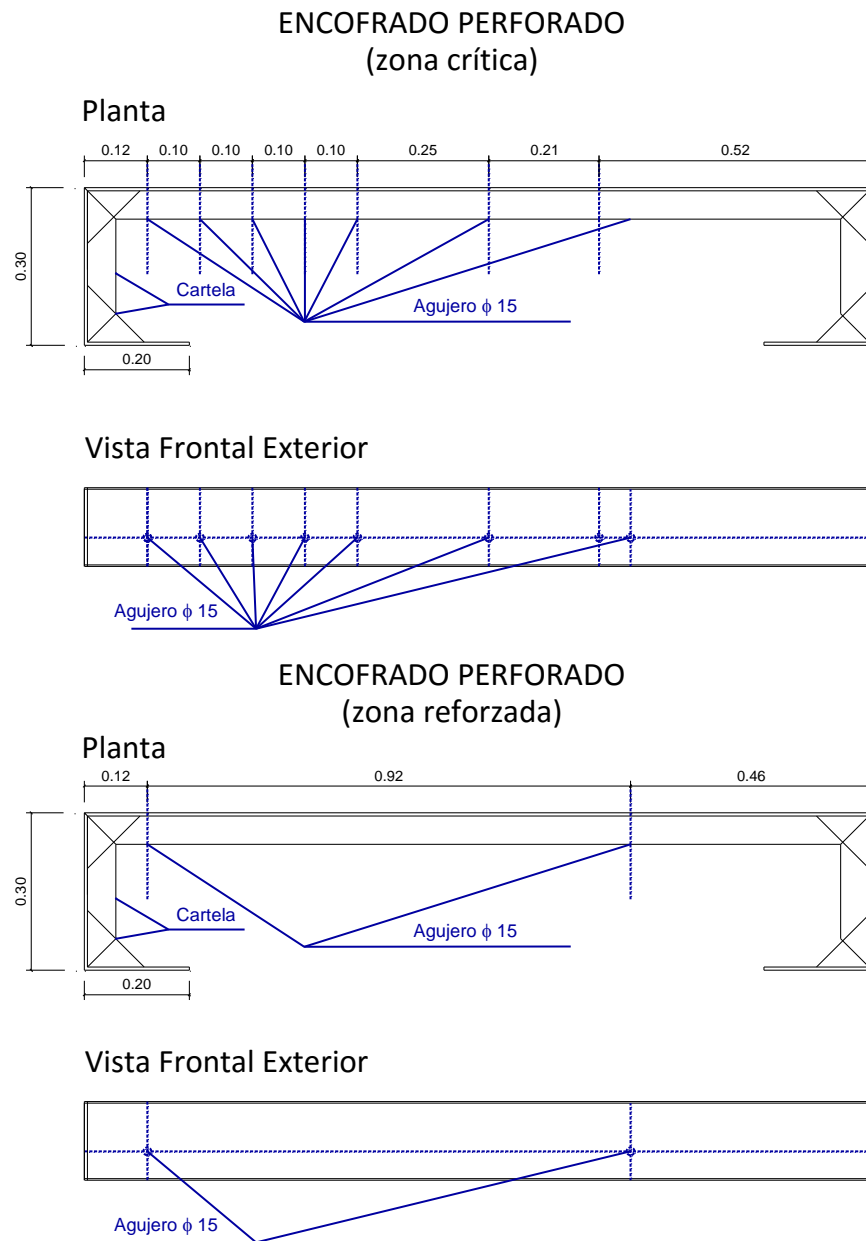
Detalle de las placas metálicas desmontables que conforman las paredes del soporte
